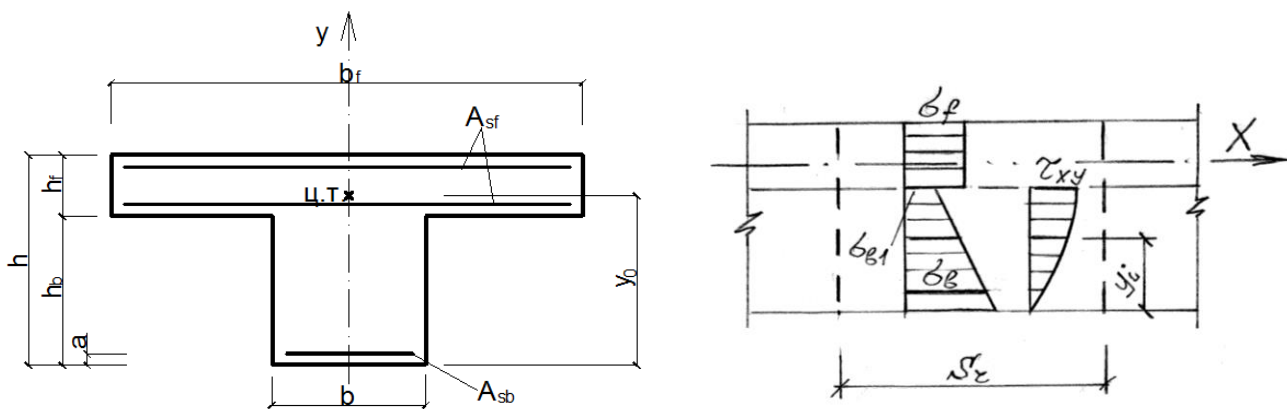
Схема к определению в железобетонном элементе таврового сечения усадочных напряжений
